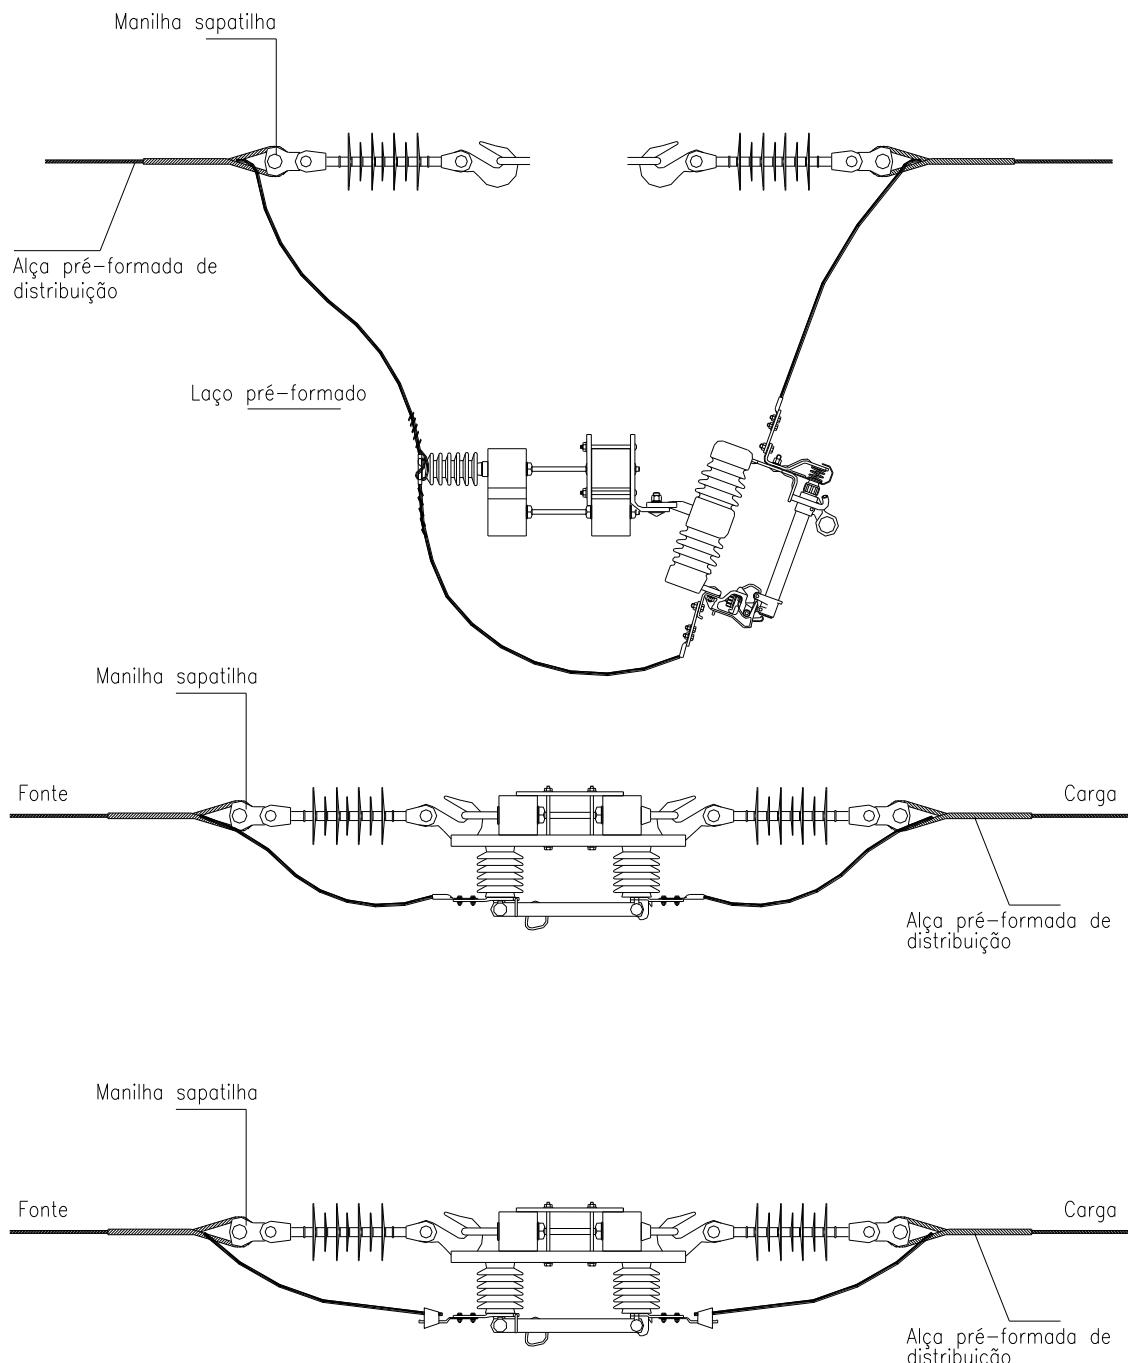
Amarrações e ligações – Primário – Chave-fusível e faca ao longo da rede
